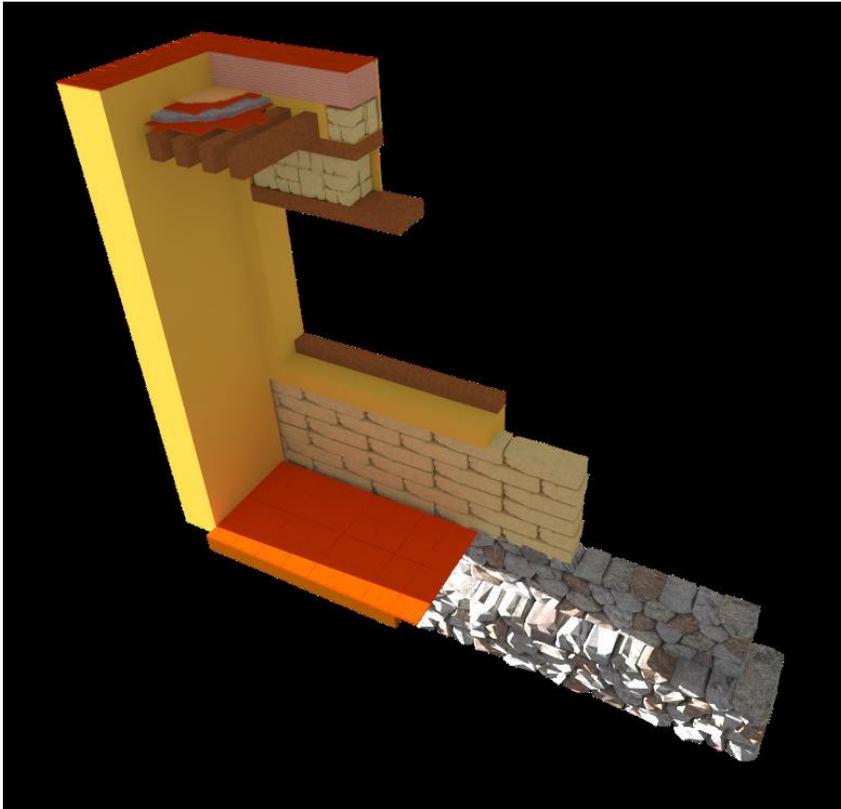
Muros mixtos de piedra braza y adobe. Elaborado por el autor
